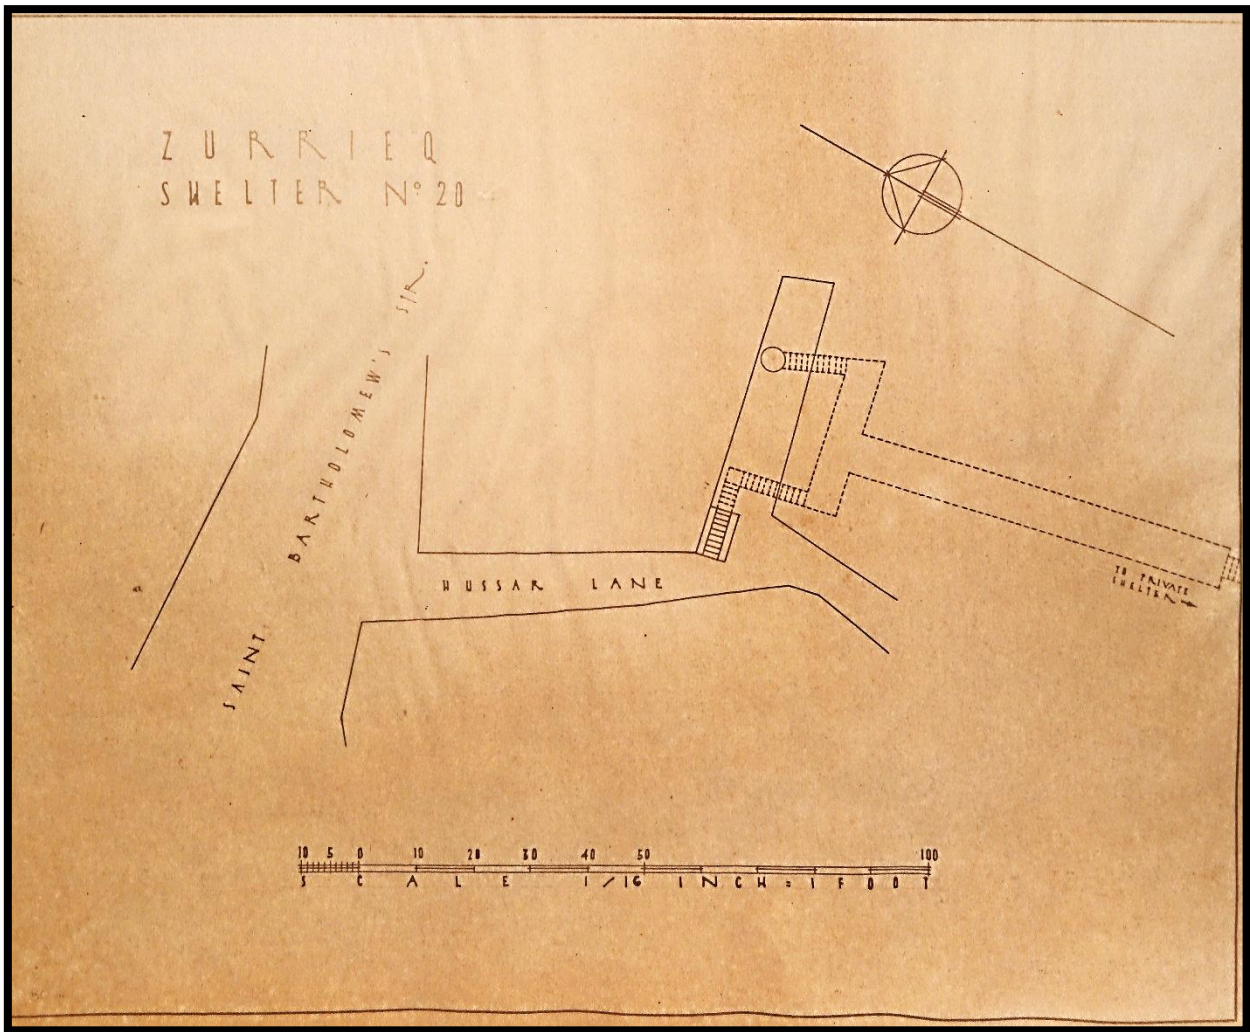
Planta do Abrigo nº20 "Saint Bartholomew's Str. – Hussar Lane"
